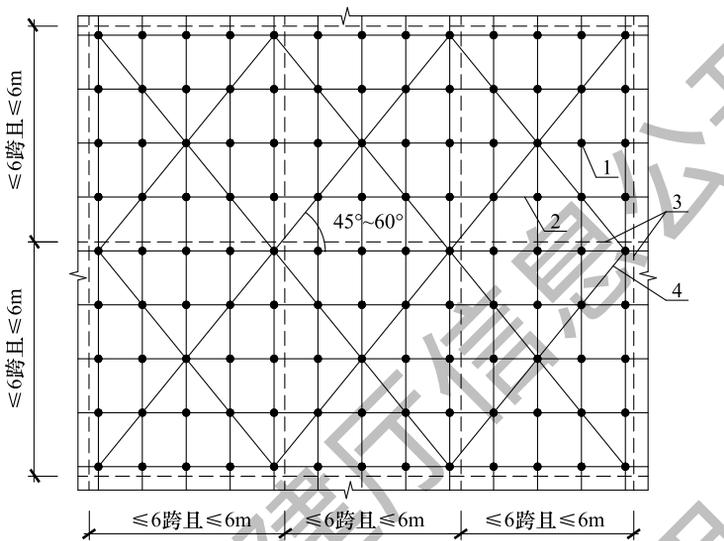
竖向剪刀撑与水平剪刀撑布置图
